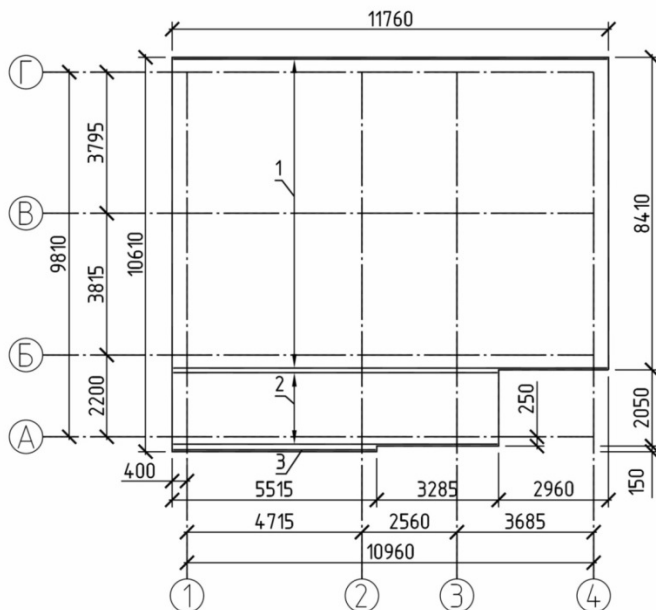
Армирование ППМ на отметке 0,000
